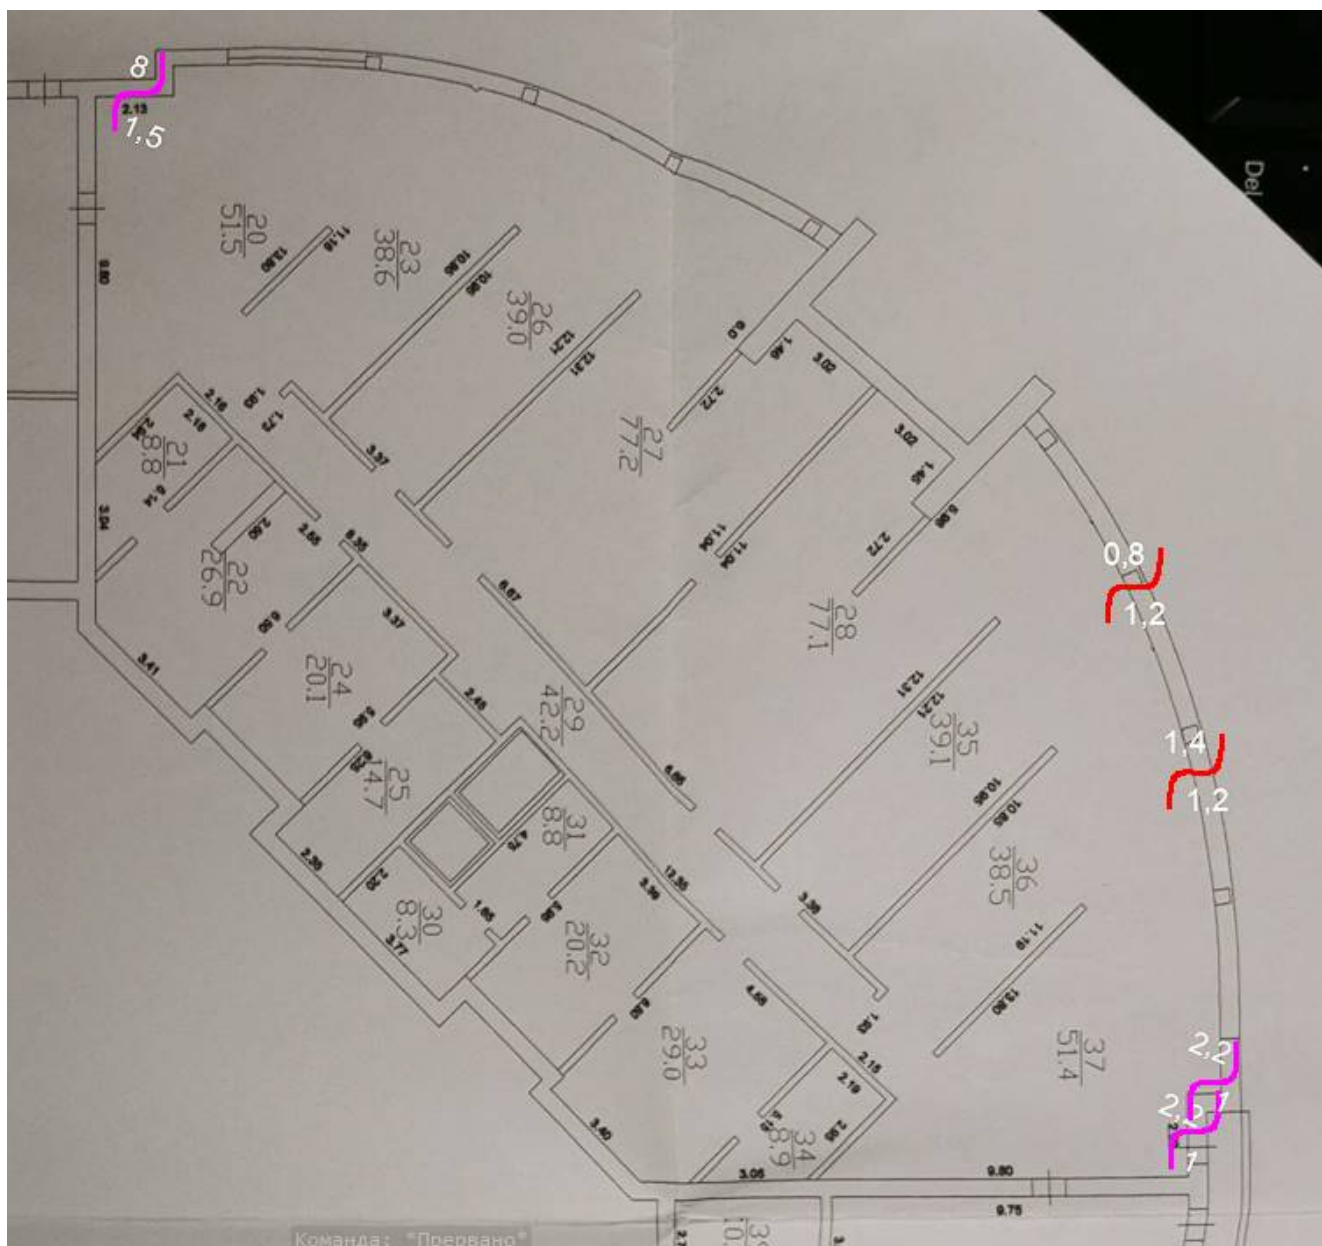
Карта дефектов подвала в зоне обследования. Фиолетовым цветом изображены трещины в кирпичной кладке наружной стены №1 строки из Приложения Б. Красным изображены трещины в монолитной железобетонной наружной стене №2 строки из Приложения Б. Сверху трещины указано значение ширины раскрытия трещины, внизу ее длина.
